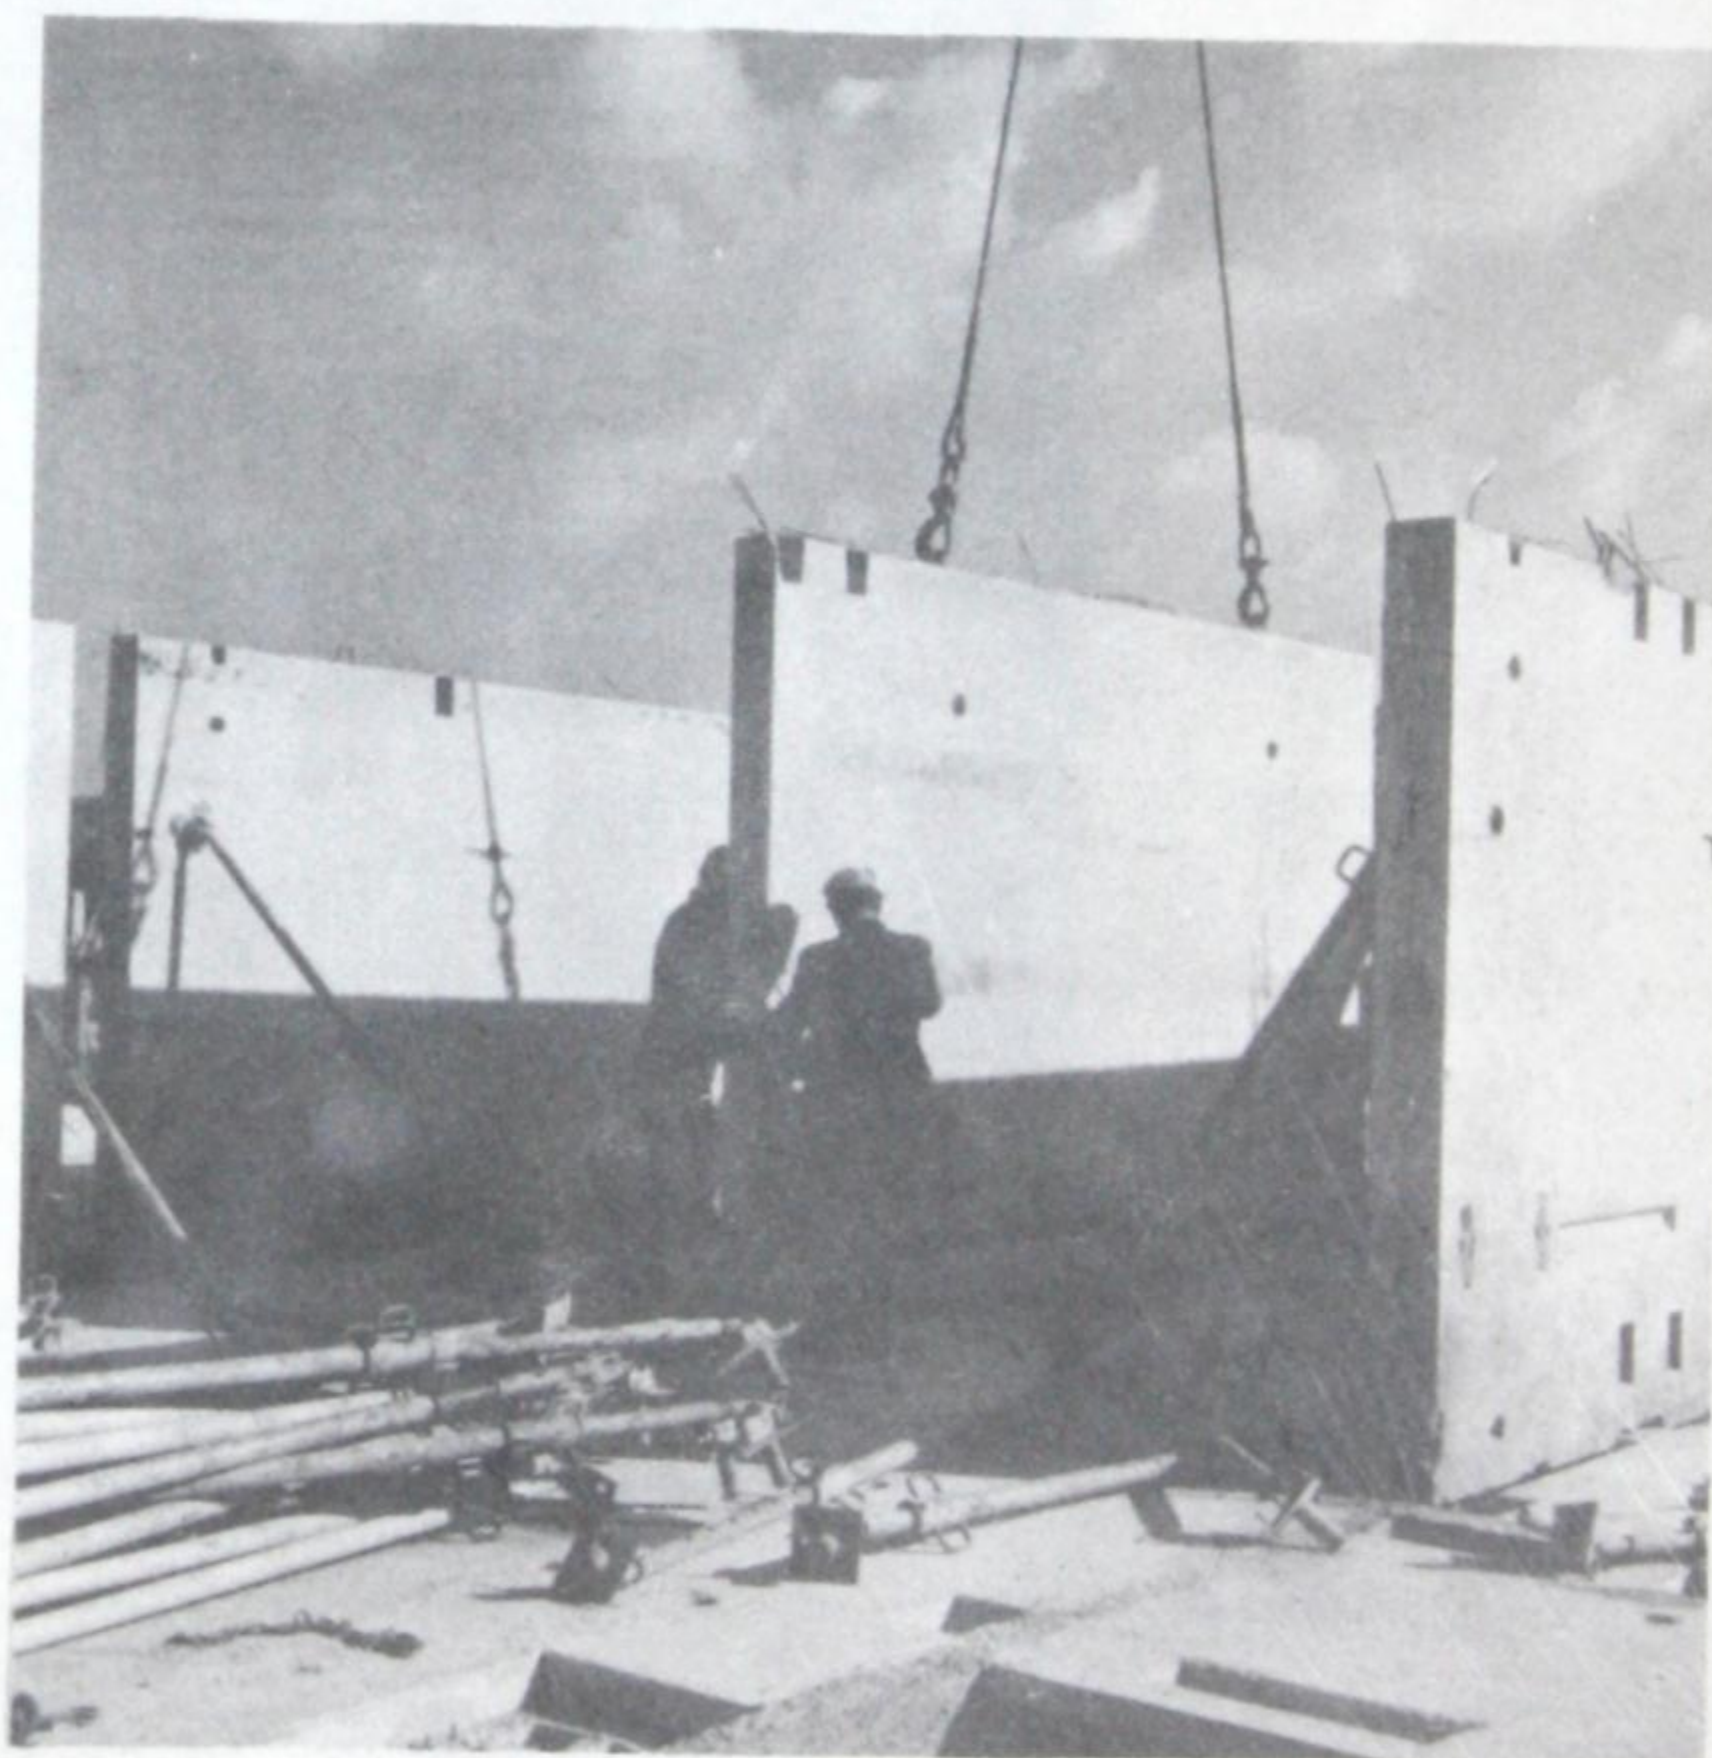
et 17 - La mise en place d'un panneau au chantier. Sur la figure de droite, on voit au premier plan les systèmes d'étaie-
